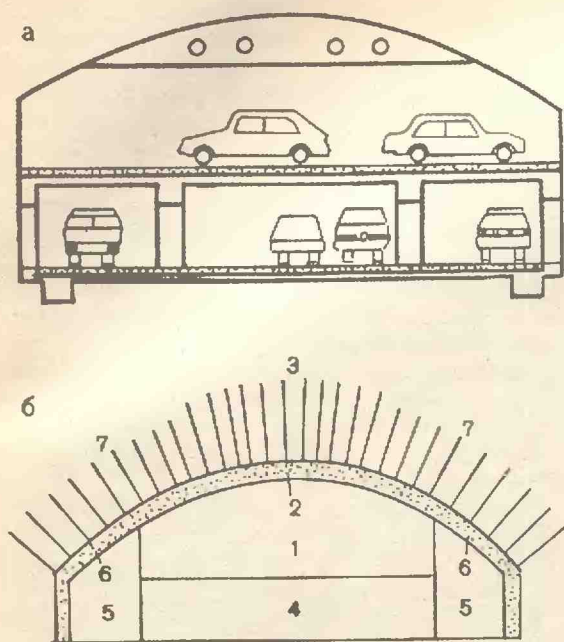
Поперечное сечение жилой подземной автостоянки (а) и этапы (1-7) раскрытия выработки (б).
